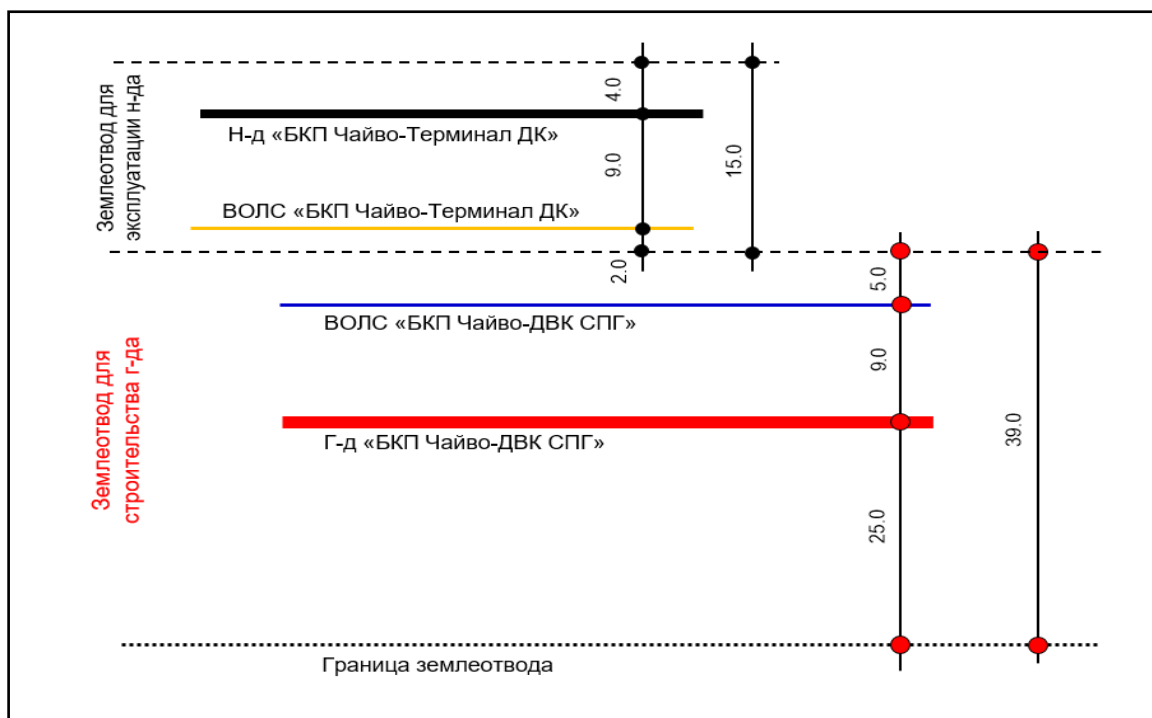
Схемы строительной полосы магистрального газопровода и кабеля ВОЛС на участке S1
